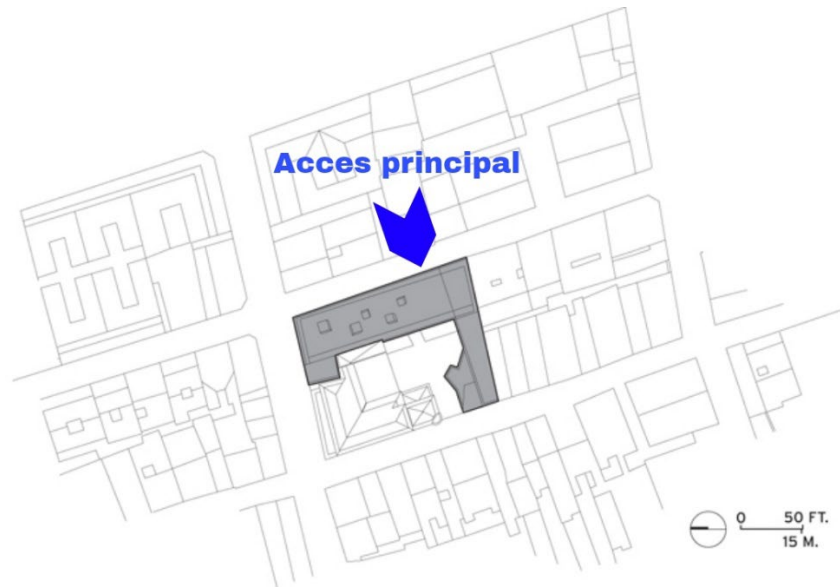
le plan de masse du musée archéologique d'Alava (archdaily.com, traitée par l'auteur).
